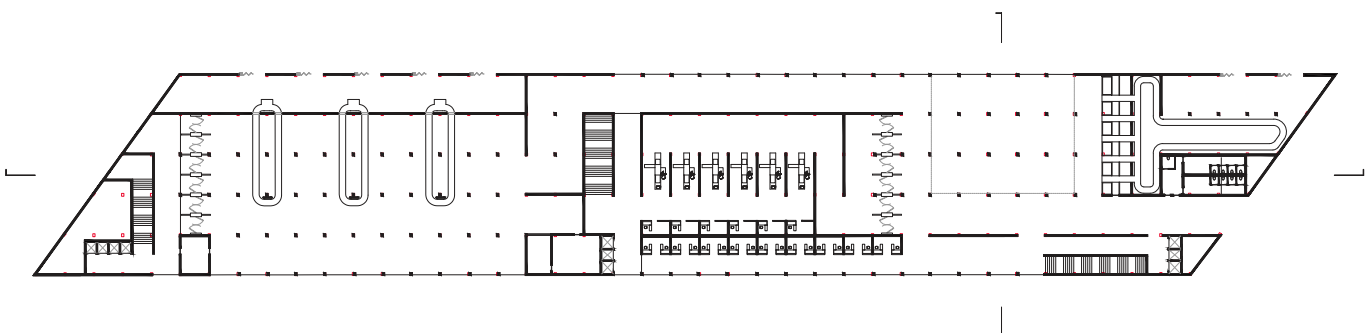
PLANTA DO PISO 0 DO TERMINAL DE CRUZEIROS
